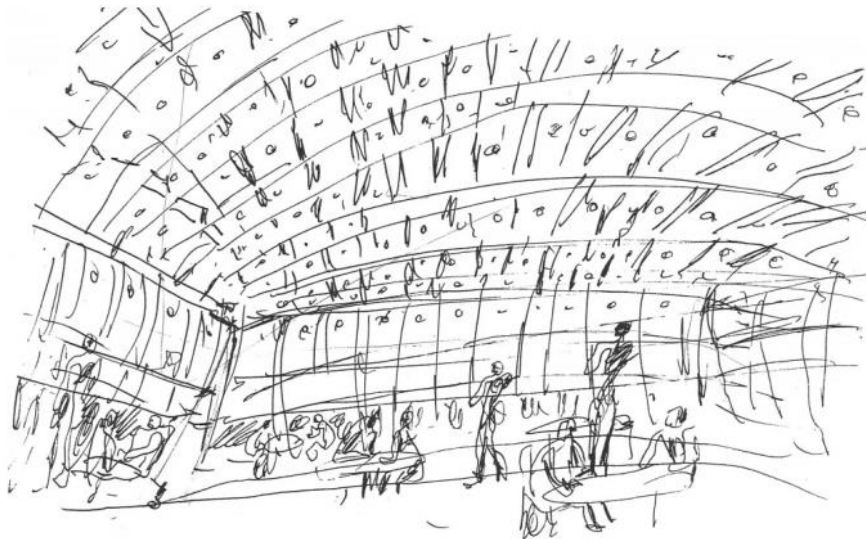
Vista interna do pavilhão - *croquis* desenvolvido por Álvaro Siza, na fase de concepção do projeto. Fonte: Projeto paramétrico (2020) adaptado pela autora (2021).
